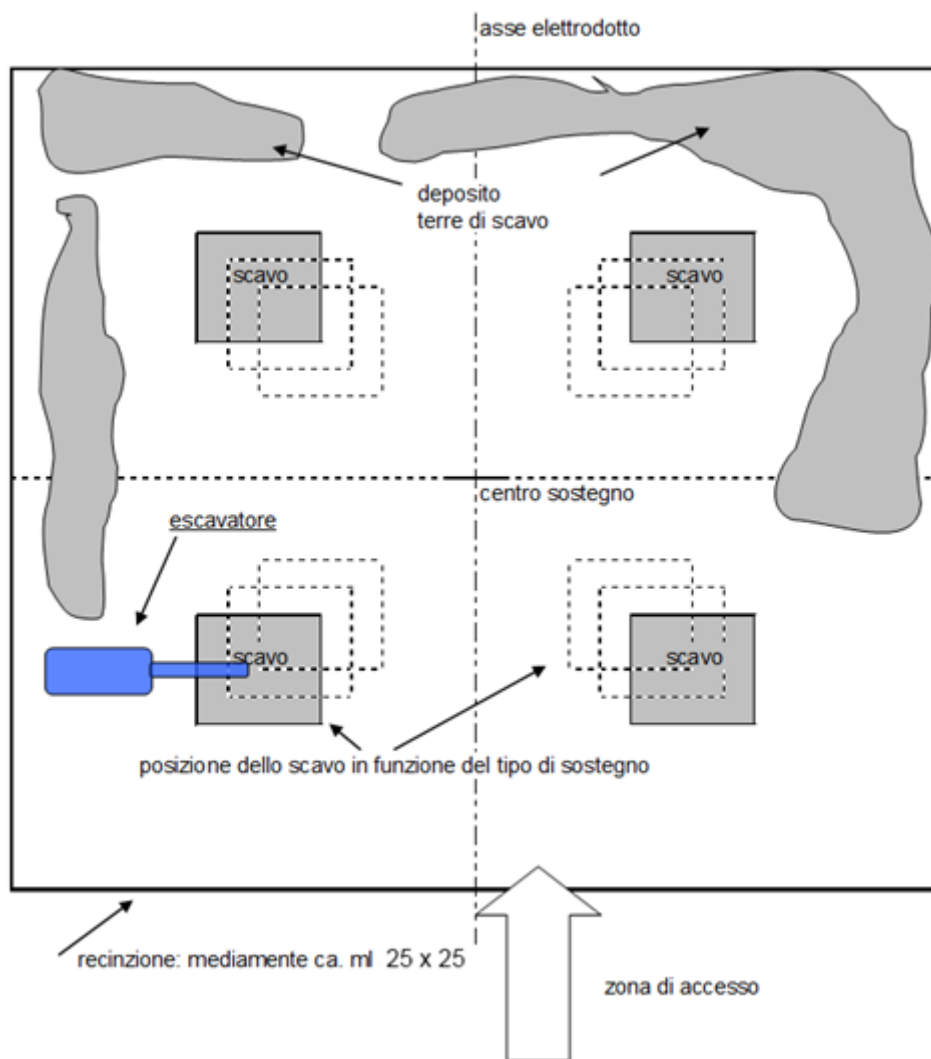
Layout tipo dell'area sostegno (scavo fondazione)
